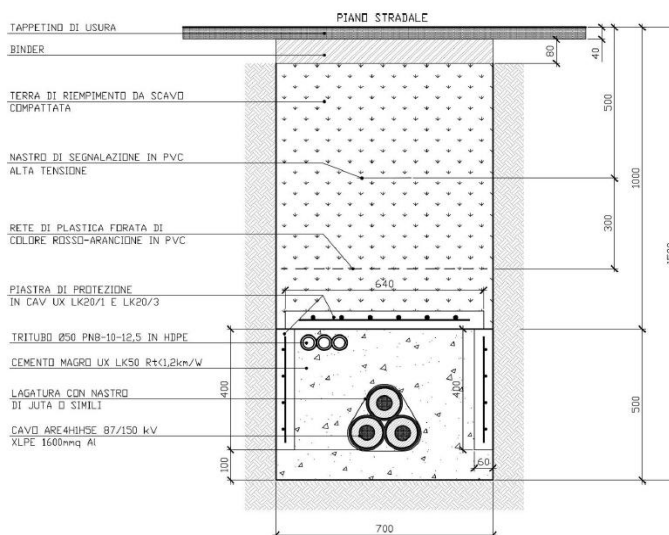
Sezione del cavidotto AT tipo sotto la strada
